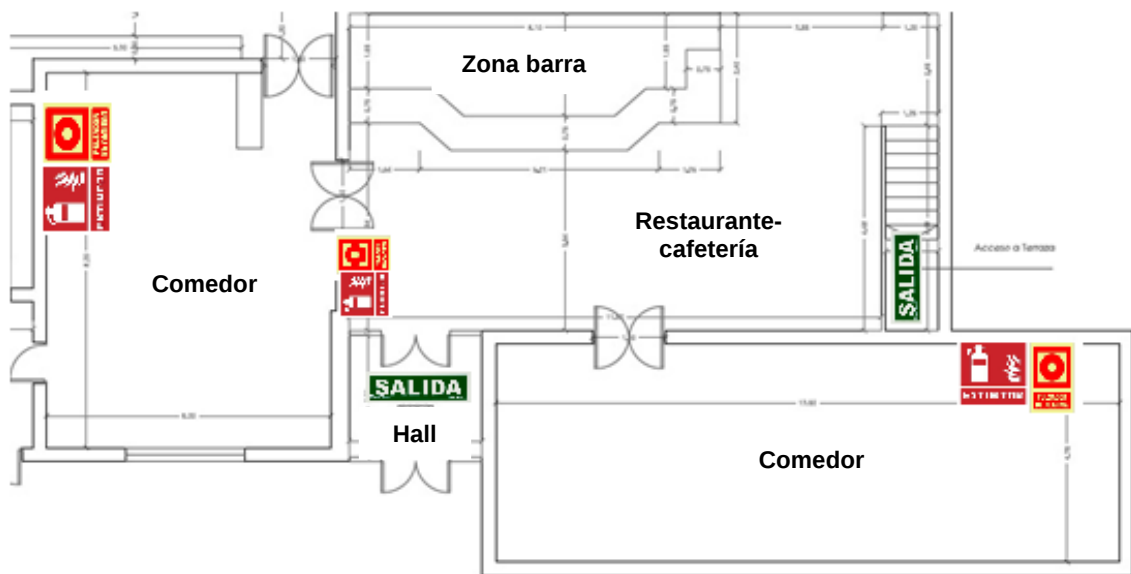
Plano del restaurante-cafetería, indicando la ubicación de los pulsadores de alarma, extintores y salidas de emergencia. (Facilitado por la propiedad).
